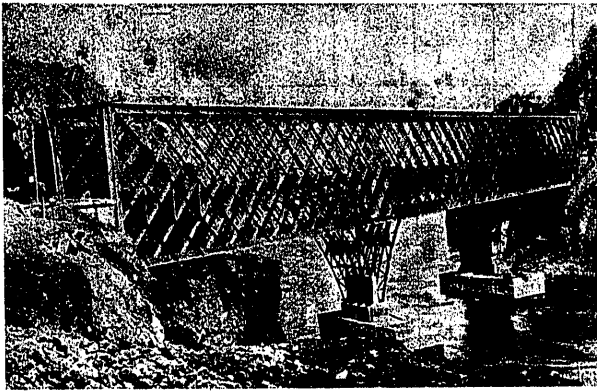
ª — Sustitución del puente metálico del Estrecho, sobre el Sil, por arcos de hormigón armado. Montaje de las armaduras rígidas.
